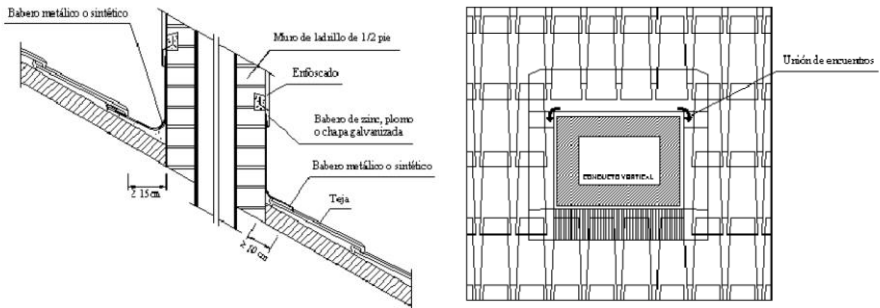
Detalle del encuentro de la cubierta con los puntos singulares. 2023.
